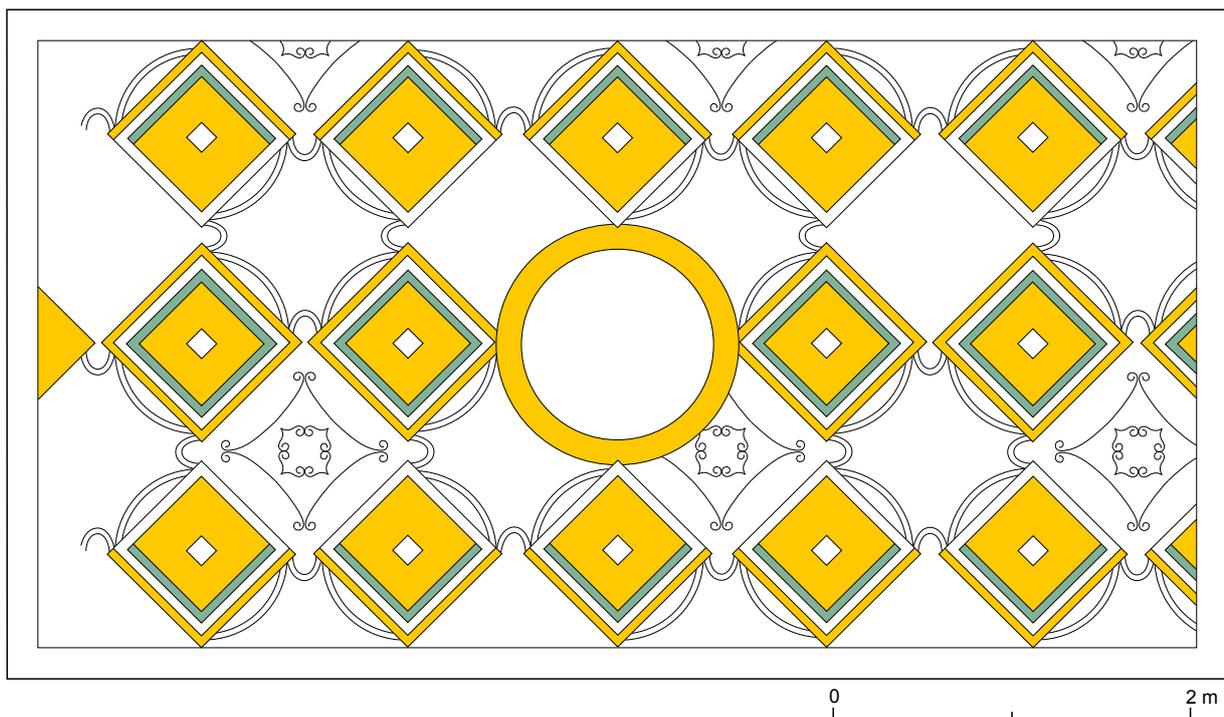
Essai de restitution du plafond peint et stucé de l'étage du pavillon
